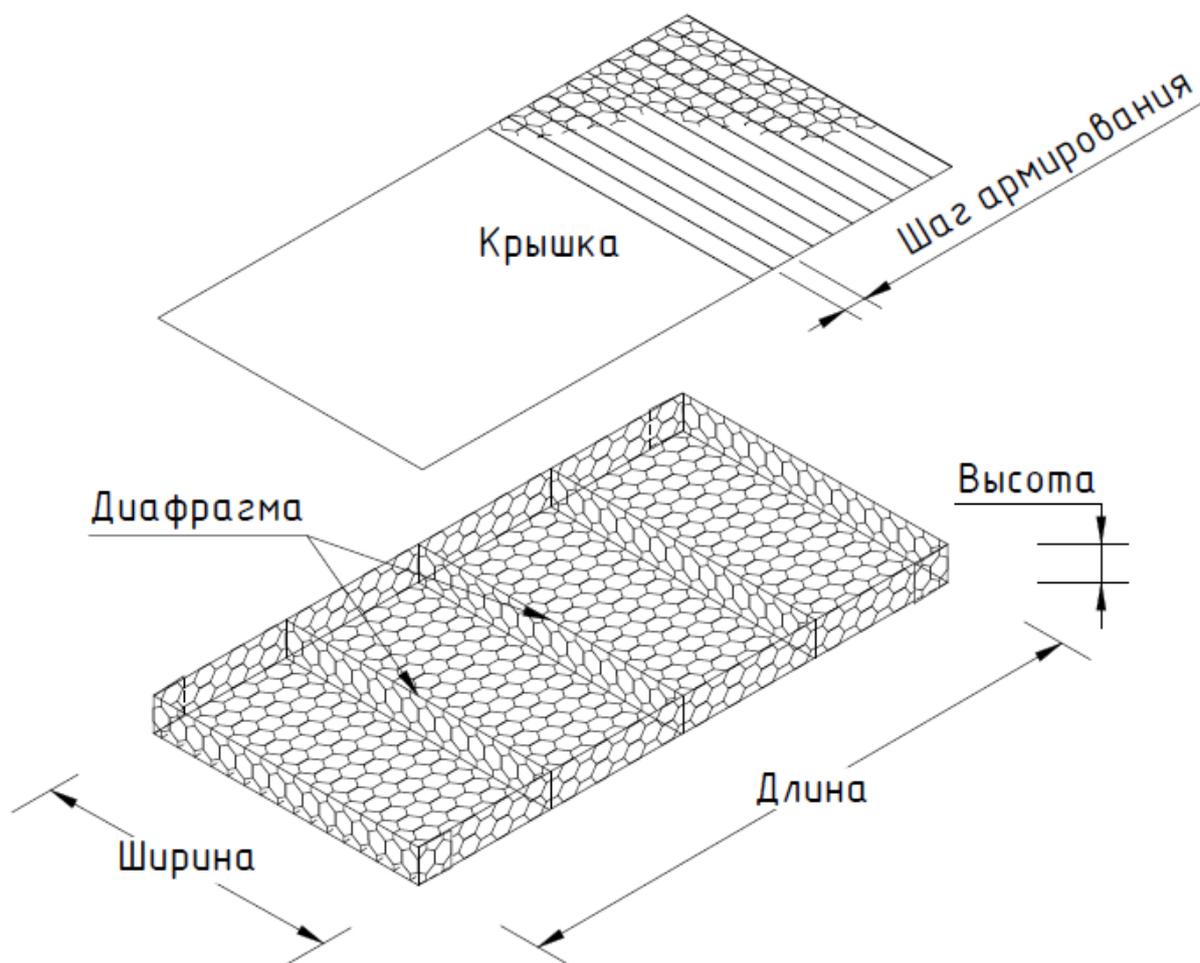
Конструктивная схема габионной конструкции матрацно-тюфячного типа (Матрац Рено™) с усиленной крышкой
